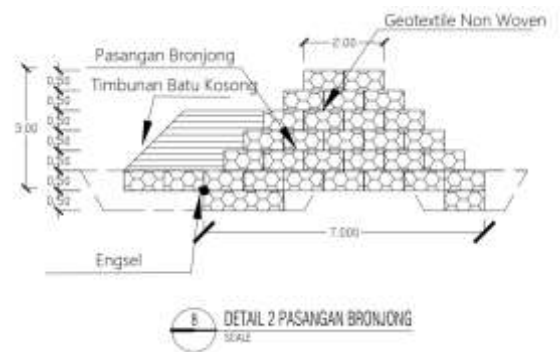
2. Potongan salah satu desain bronjong di lokasi 2.
